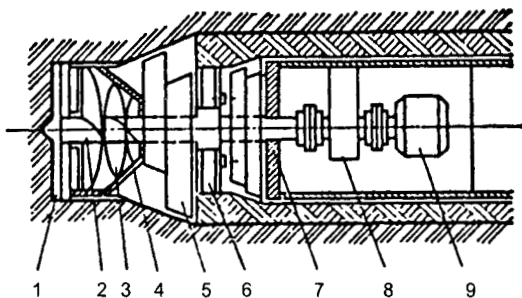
Горизонтальное бурение выработки под трубопровод грунтораскатывающей установкой:
